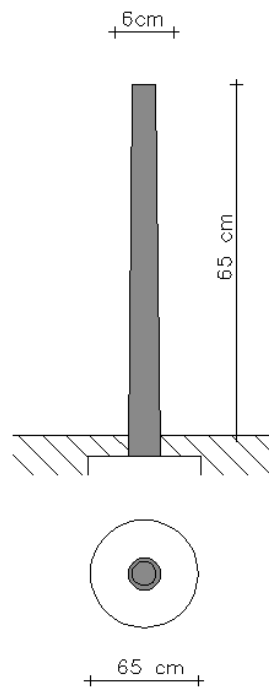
Exemplo de pilaretes (anexo c.05)
